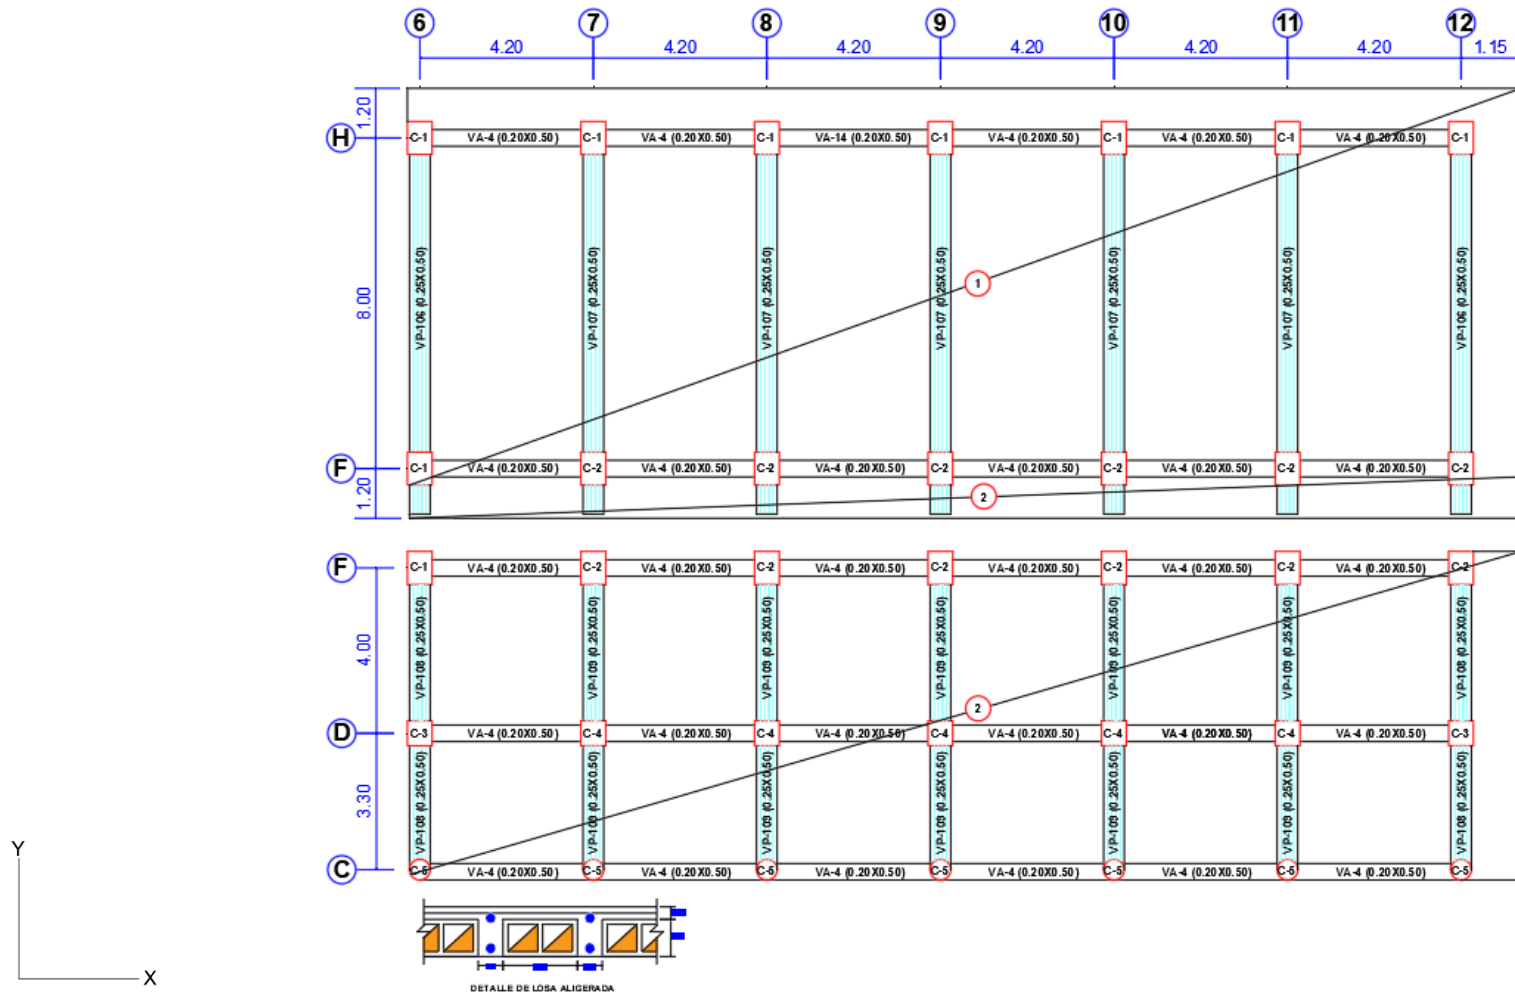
Distribución de los elementos estructurales del Segundo Nivel (Fuente: Archivos del Área de Archivo Central, de las obras ejecutadas en la Universidad Nacional de San Martín – Tarapoto)
